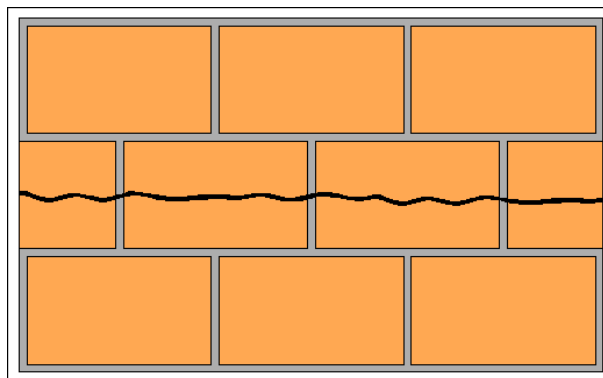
Fissuração horizontal devido ao esmagamento do bloco
